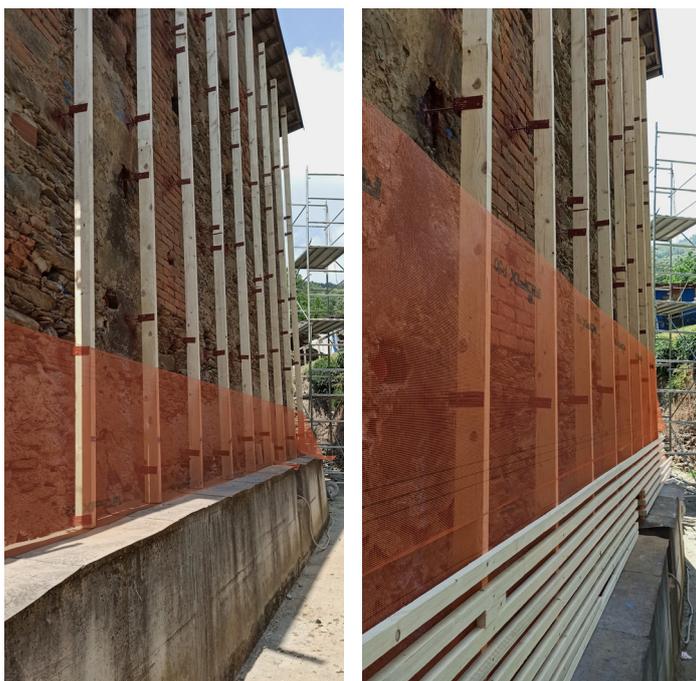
Da sinistra: fissaggio della rete di contenimento e posizionamento dei listelli orizzontali
